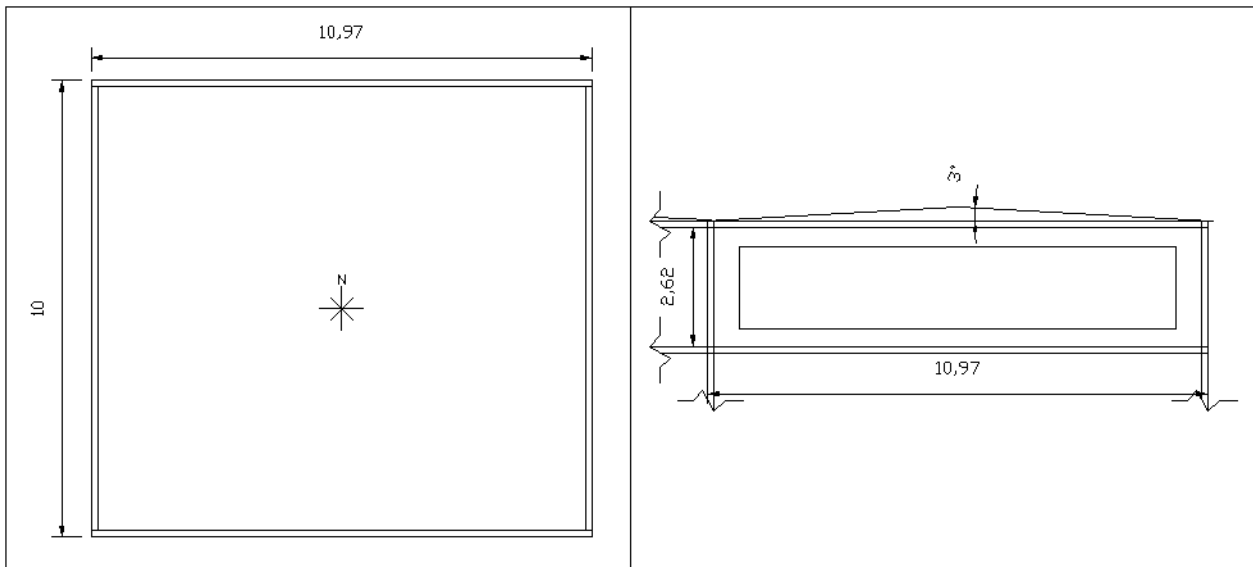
Vista en planta y elevación XX. Unidades en metro.
